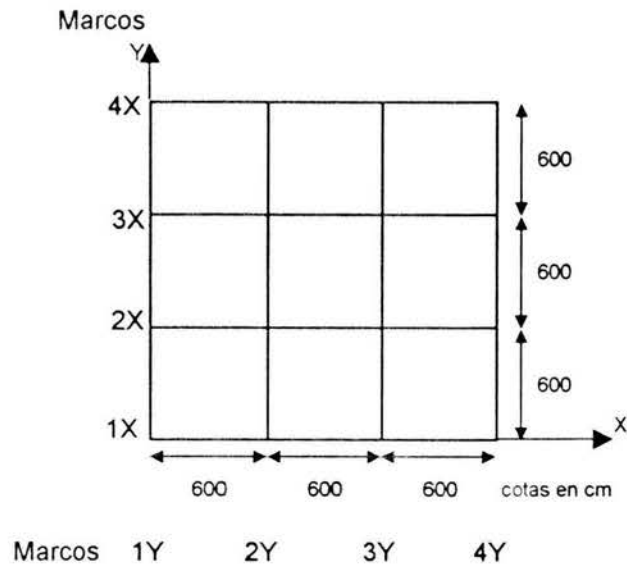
Distribución en planta de los marcos de un edificio simétrico de 12 pisos rígido.
